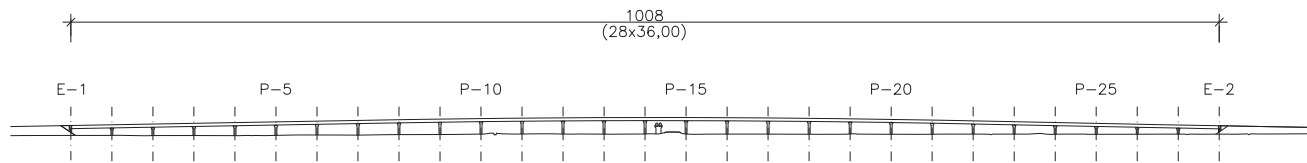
Alzado Viaducto sobre el Tránsito Tajo-Segura.
